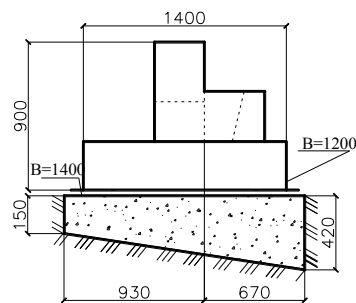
Блочний ступінчатий фундамент з бетонною підготовкою
